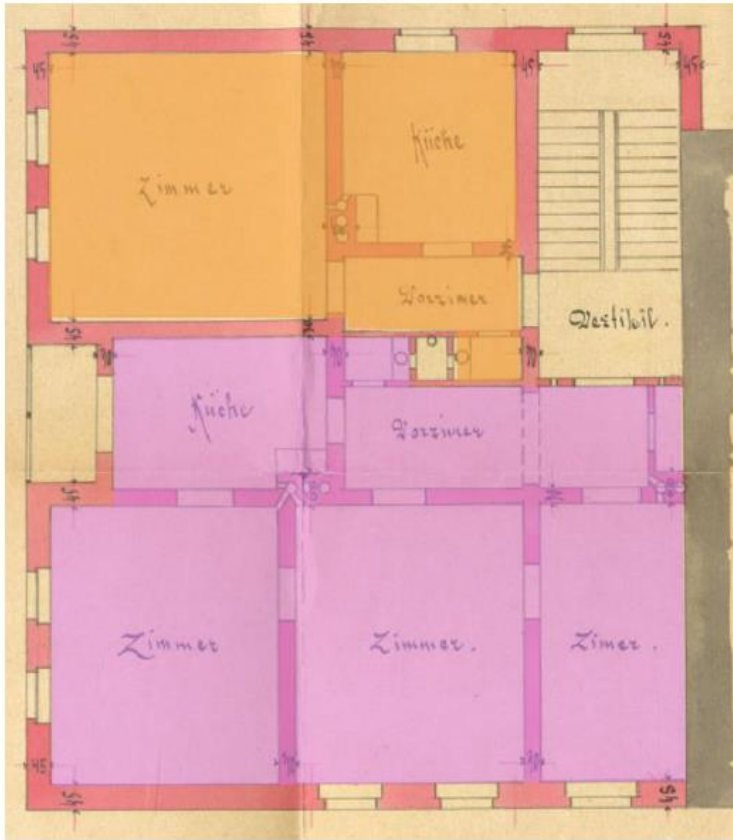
Grundriss eines Mietshauses im ersten und zweiten Stock⁶⁹
